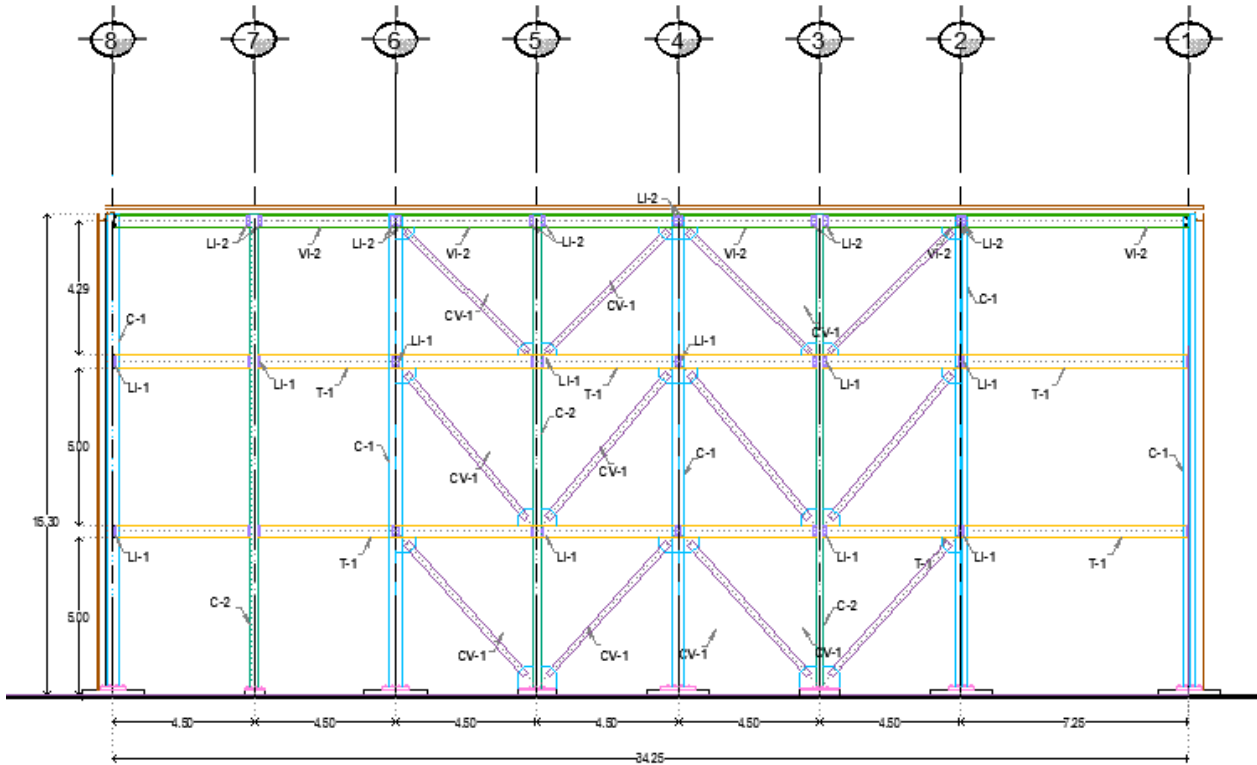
Arreglo estructural para casa de máquinas (Vista lateral)
